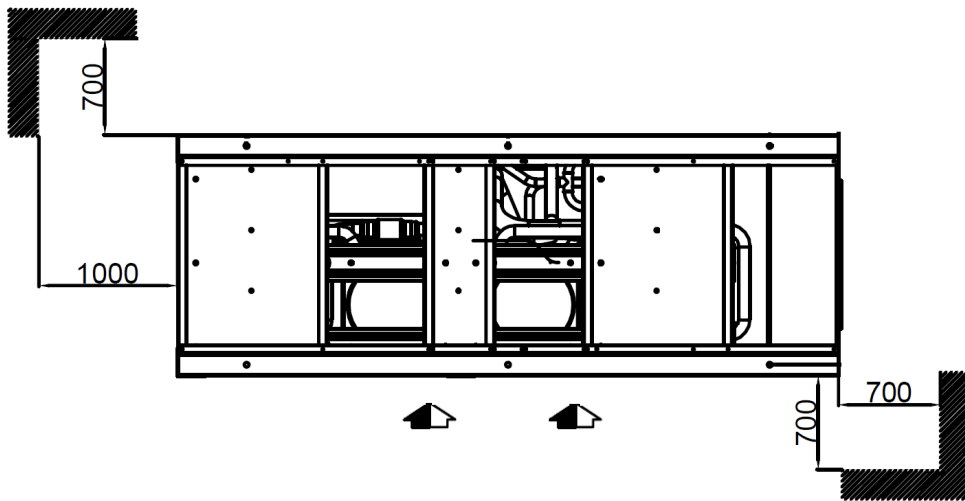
Mindestplatzbedarf [mm] für Plattform-3-Maschinen
